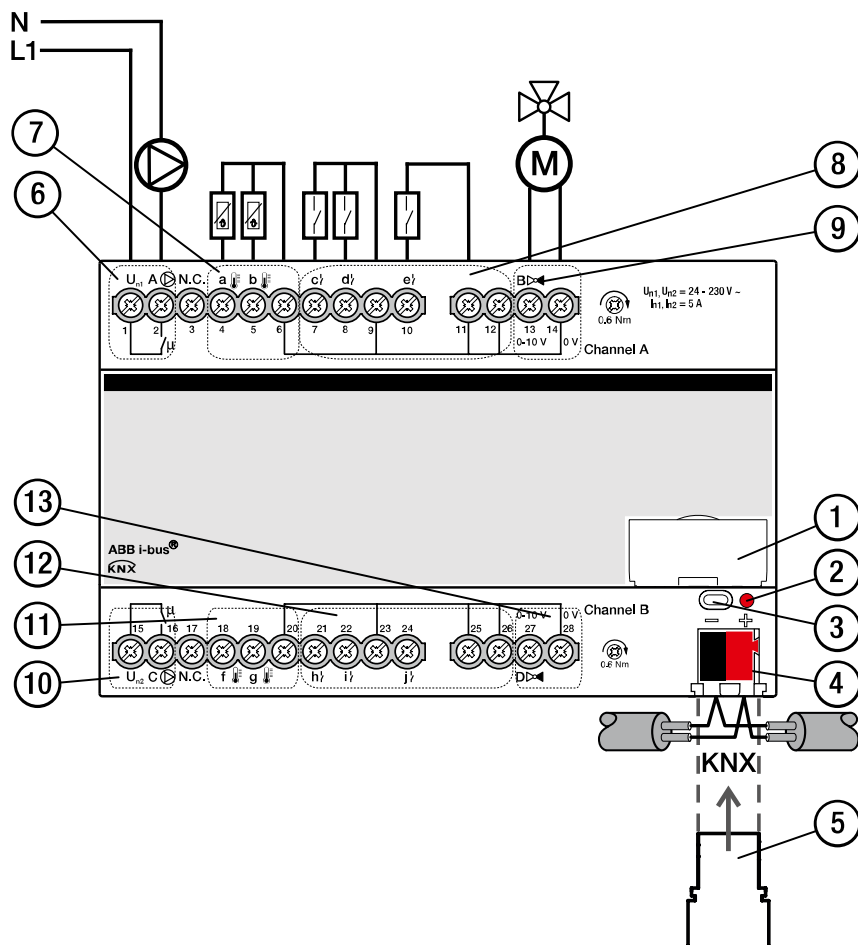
Schema di collegamento HCC/S 2.1.1.1
